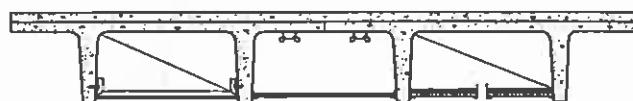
Painéis metálicos e difusores em painéis TT (3)
